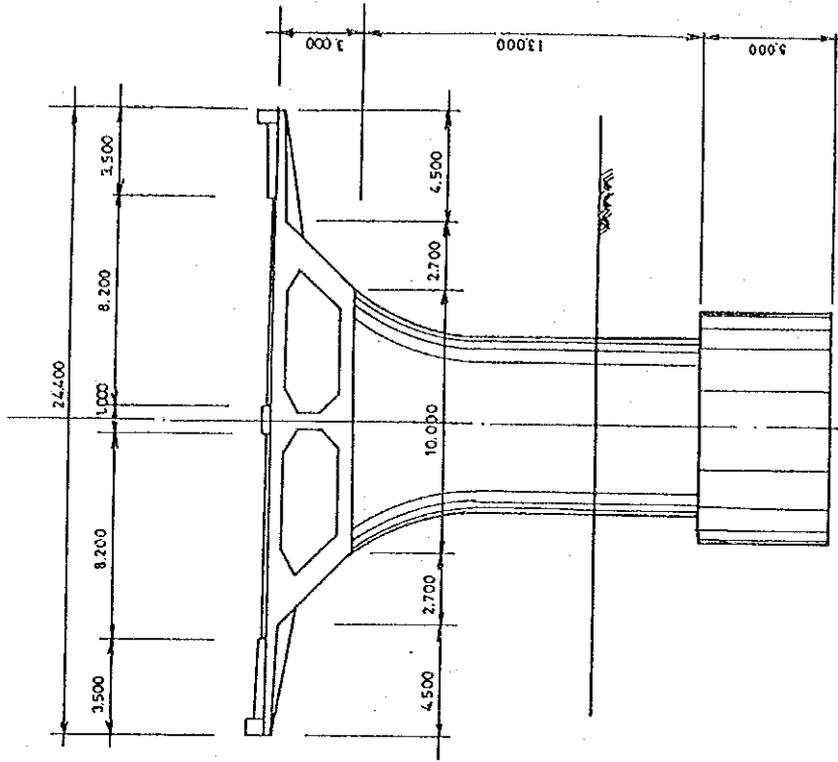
Puente de Viga Continua Tipo Cajón,
